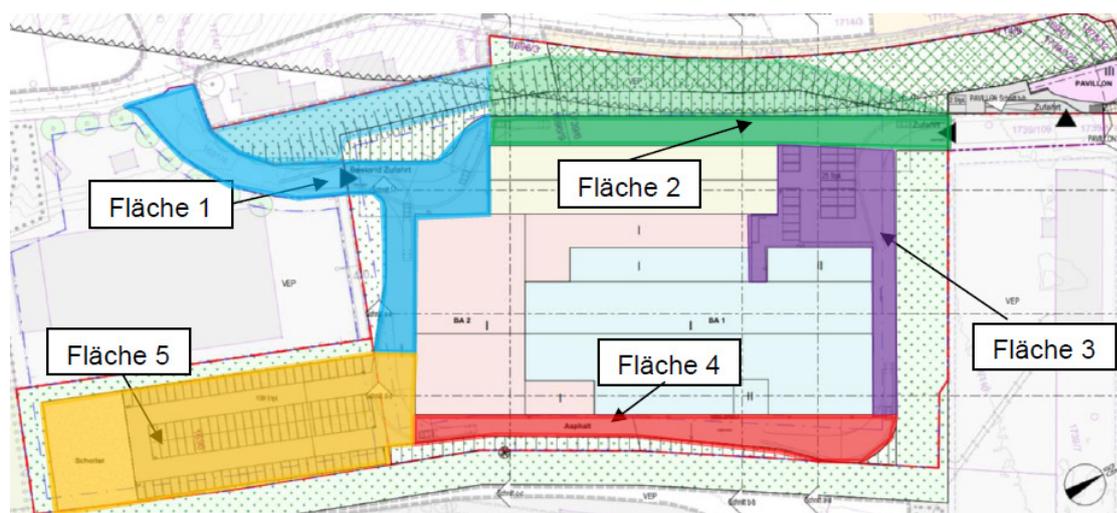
Darstellung abflussrelevante Flächen 1 bis 5 (Grundlage:VE-Plan, Papadopoulos Associates GmbH, Stand 01.02.2024) aus [19]
